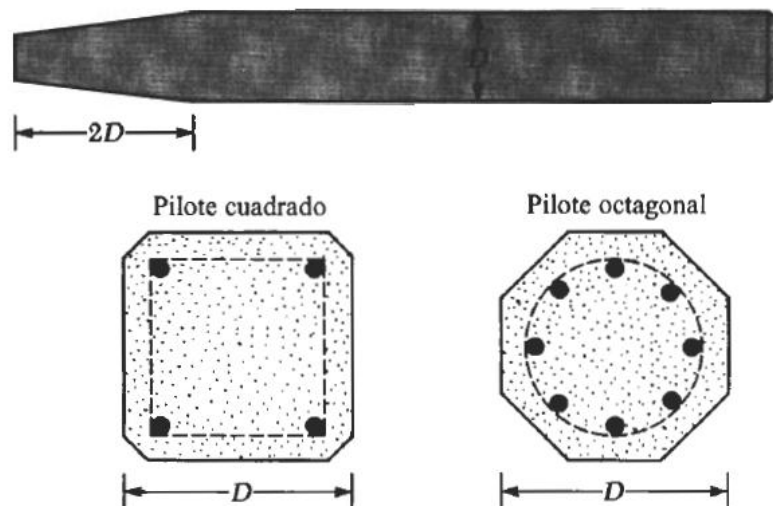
Pilotes prefabricados con refuerzo ordinario.
